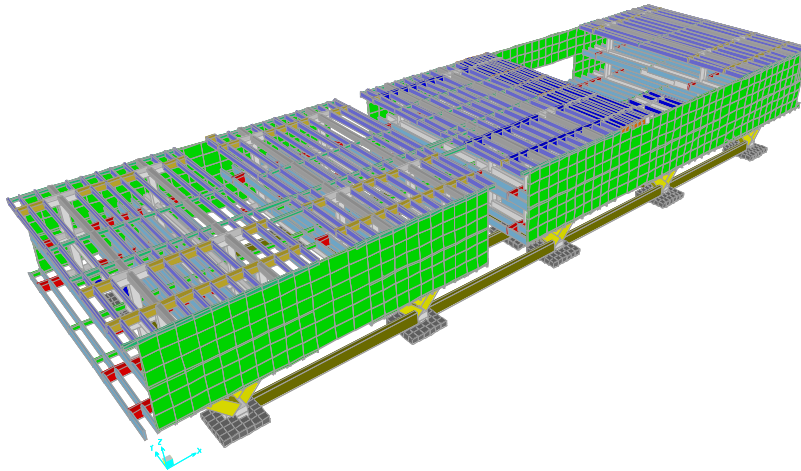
Modelo tridimensional de las columnas, vigas y muros.
